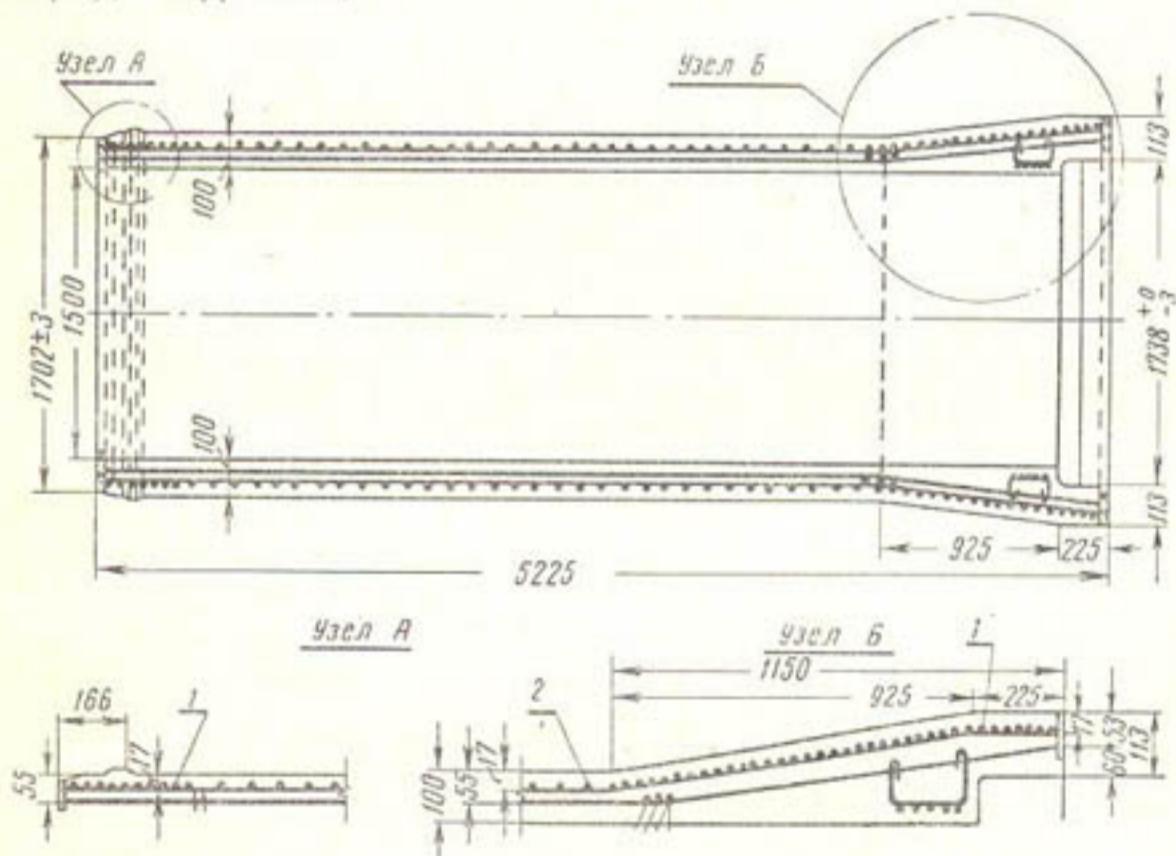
Железобетонная деталь «ТНР-150» — труба из напряженного железобетона диаметром 1500 мм:
